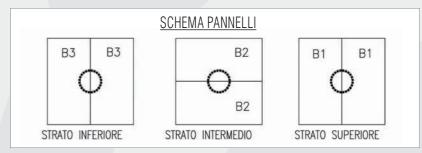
Disposizione dei moduli FAST SITE® SYSTEM 24
